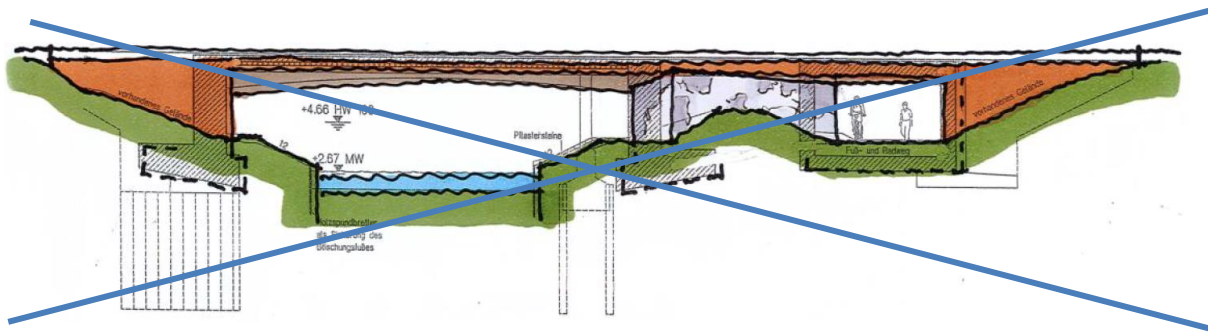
Planung des Ersatzneubaus BW 443 - 443 – Längsschnitt Rahmentragwerk und Unterführungsbauwerk
